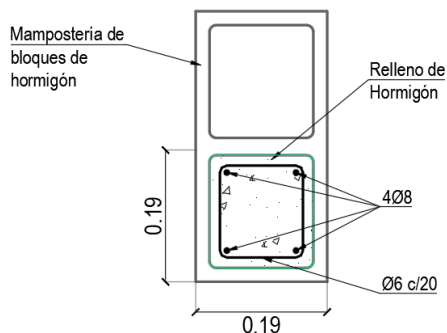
REFUERZOS VERTICALES | ESQUEMA
